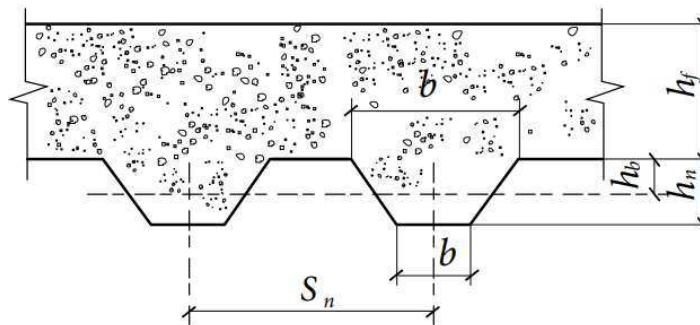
Схема для определения приведенной толщины бетона
